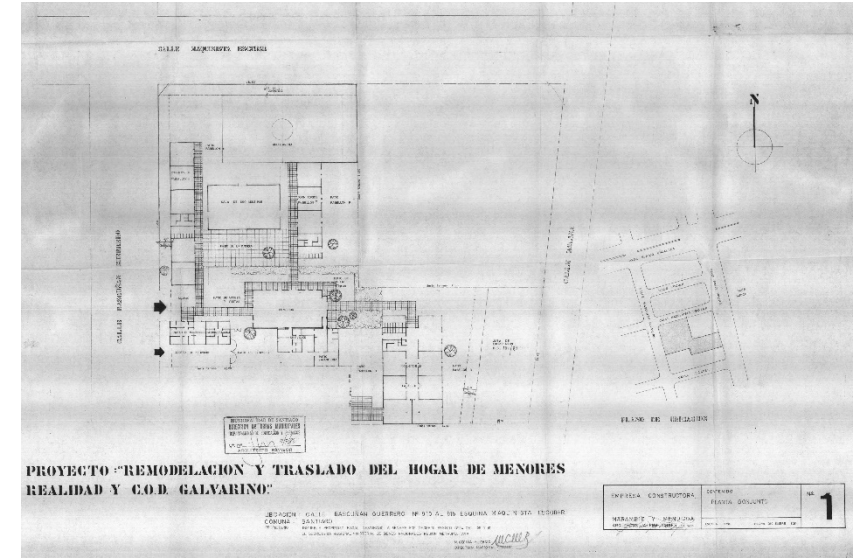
Planta proyectos original. Archivo DOM Santiago.
